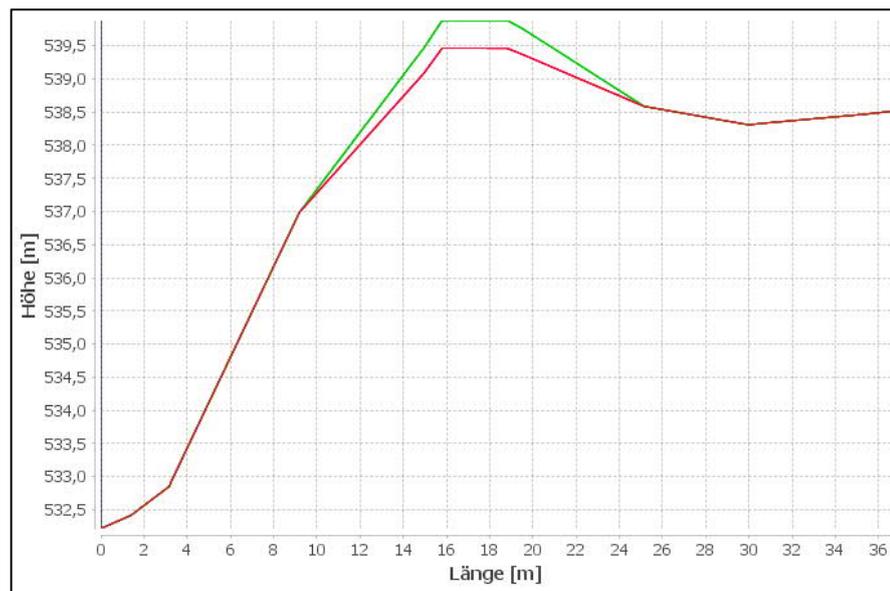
Sanierung des rechten Damms Trimmis Industrie, Querschnitt etwa bei km 16.6 mit leichter Dammerhöhung rund 30 cm
